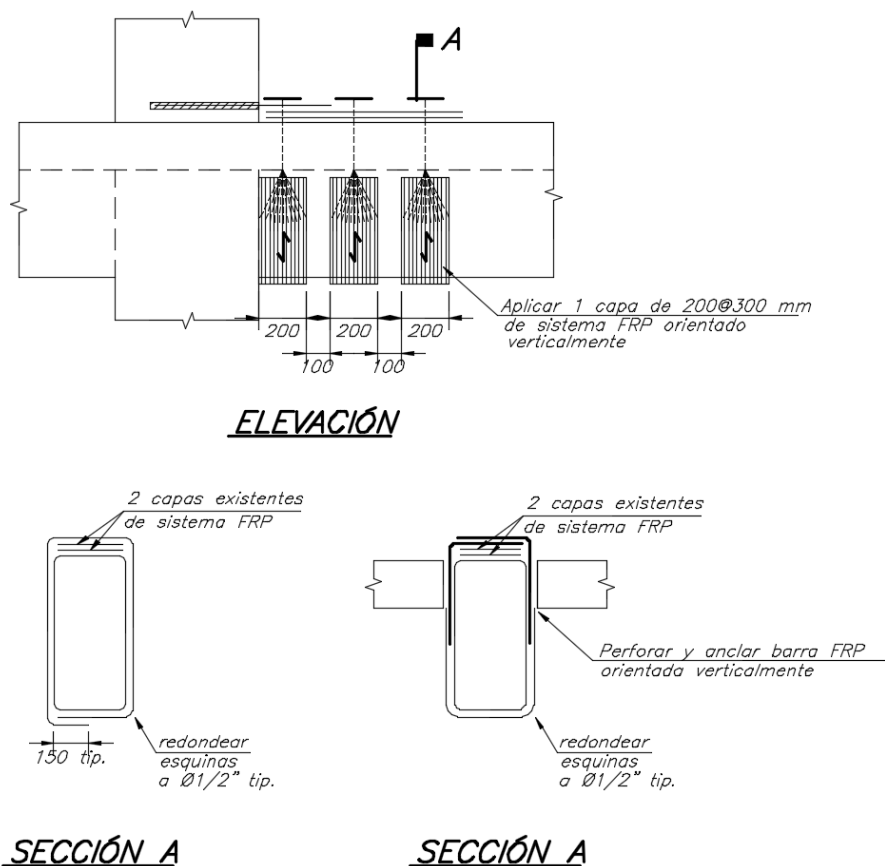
Elevación y detalle de refuerzo adicional por confinamiento con FRP para mejorar resistencia a la compresión.
